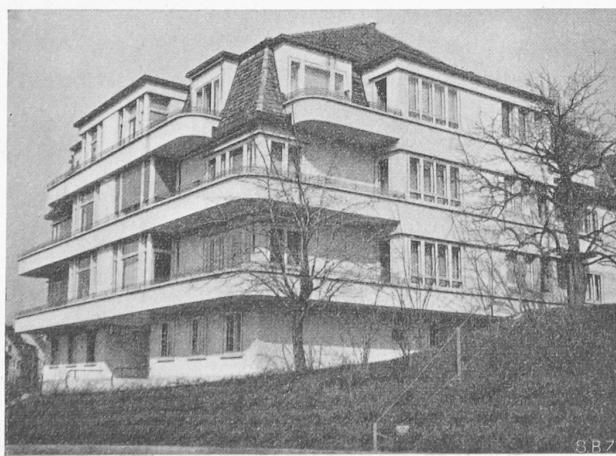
„Normale“ Dachgeschossausbildung in der ehemaligen Zone 2 der offenen Bebauung (Zürichberg). Im Untergeschoss außerdem Dienstzimmer.
